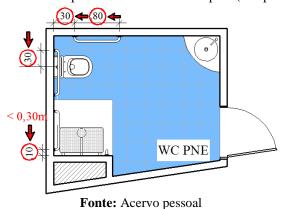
Planta Baixa de WC adaptada a PNE - Barras de apoio (comprimento e posicionamento)
